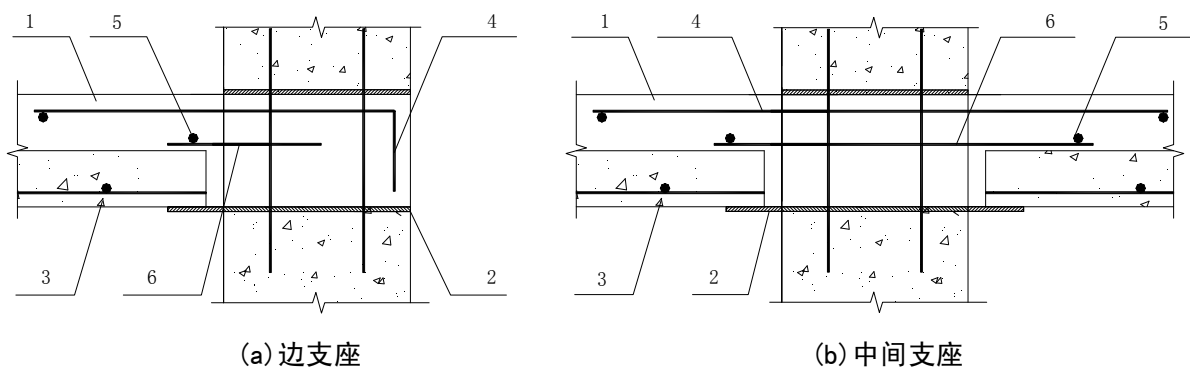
叠合楼板与排钢管混凝土构件连接节点
